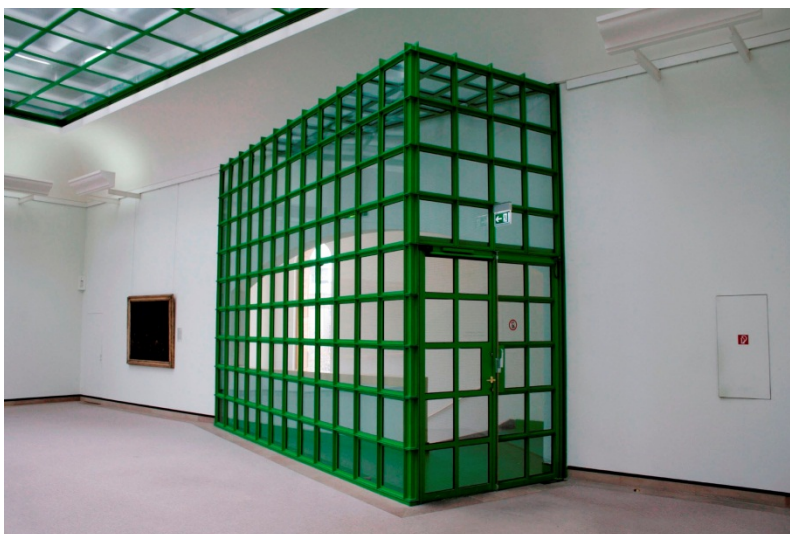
Windfang Ausstellungsbereich Obergeschoss – Übergang Altbau Neubau;
